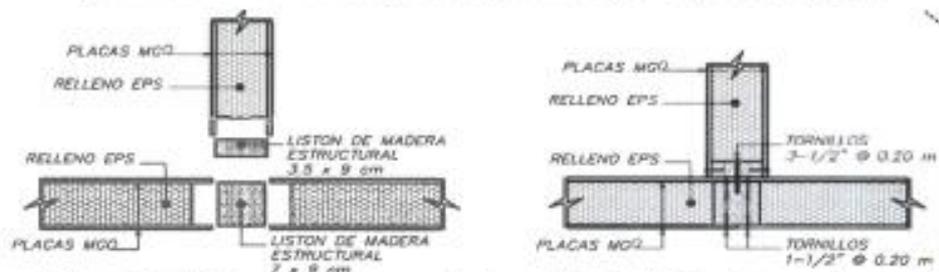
Unión entre tres paneles (conexión tipo "T"), vista en planta
